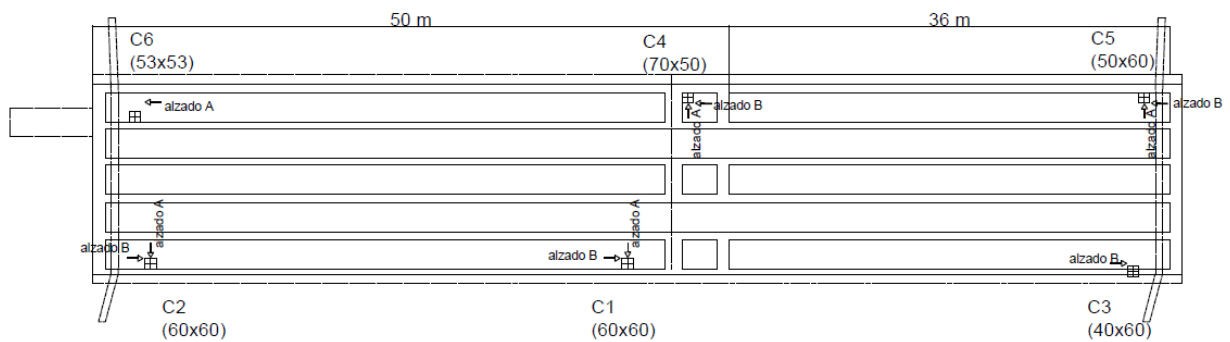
Vista en planta y distribución de las vigas cajón del puente
